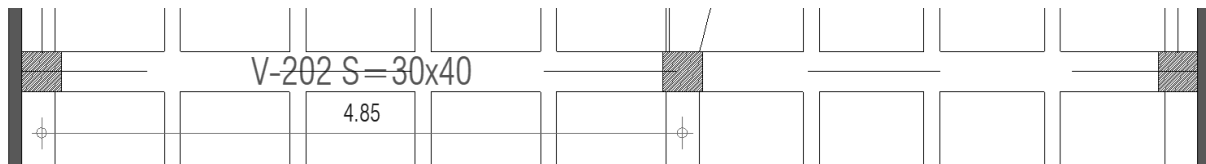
Determinación del Tipo de Apoyo y Altura de las Vigas. Fuente: Propia
